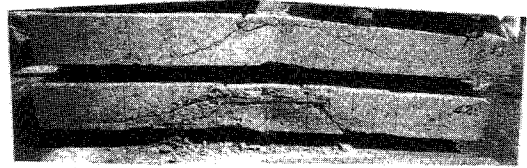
押抜きせん断ひびわれ(主鉄筋断面)
